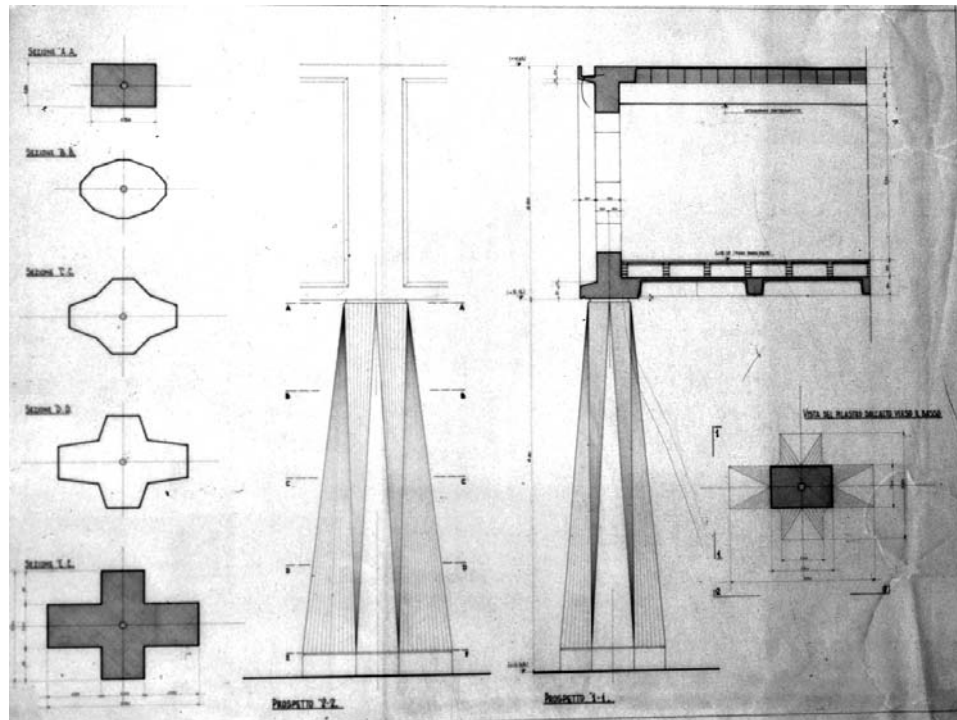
Particolari architettonici dei pilastri (Archivio Nervi - CSAC)
